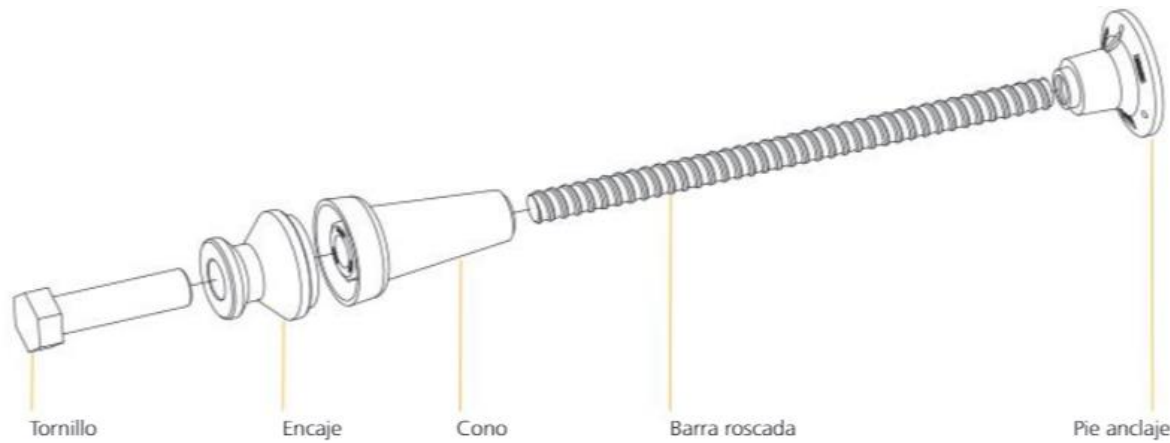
Detalle del sistema de anclaje para encofrado tipo trepante. Recuperado de: Ulma Construction, *Anclajes. Sistema de anclaje consola trepado.
